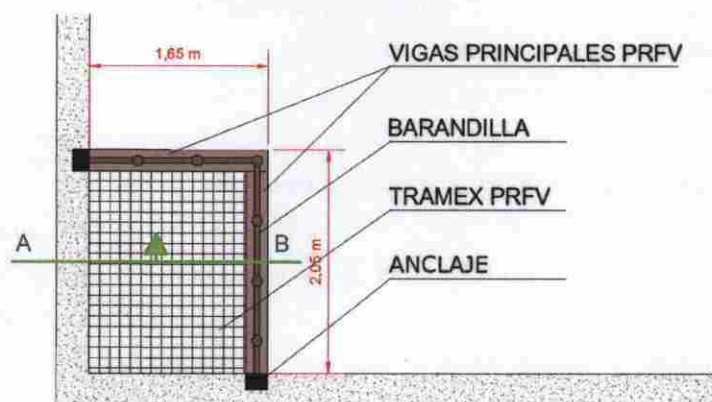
Planta de la estructura de PRFV. Fuente: *Elaboración propia
